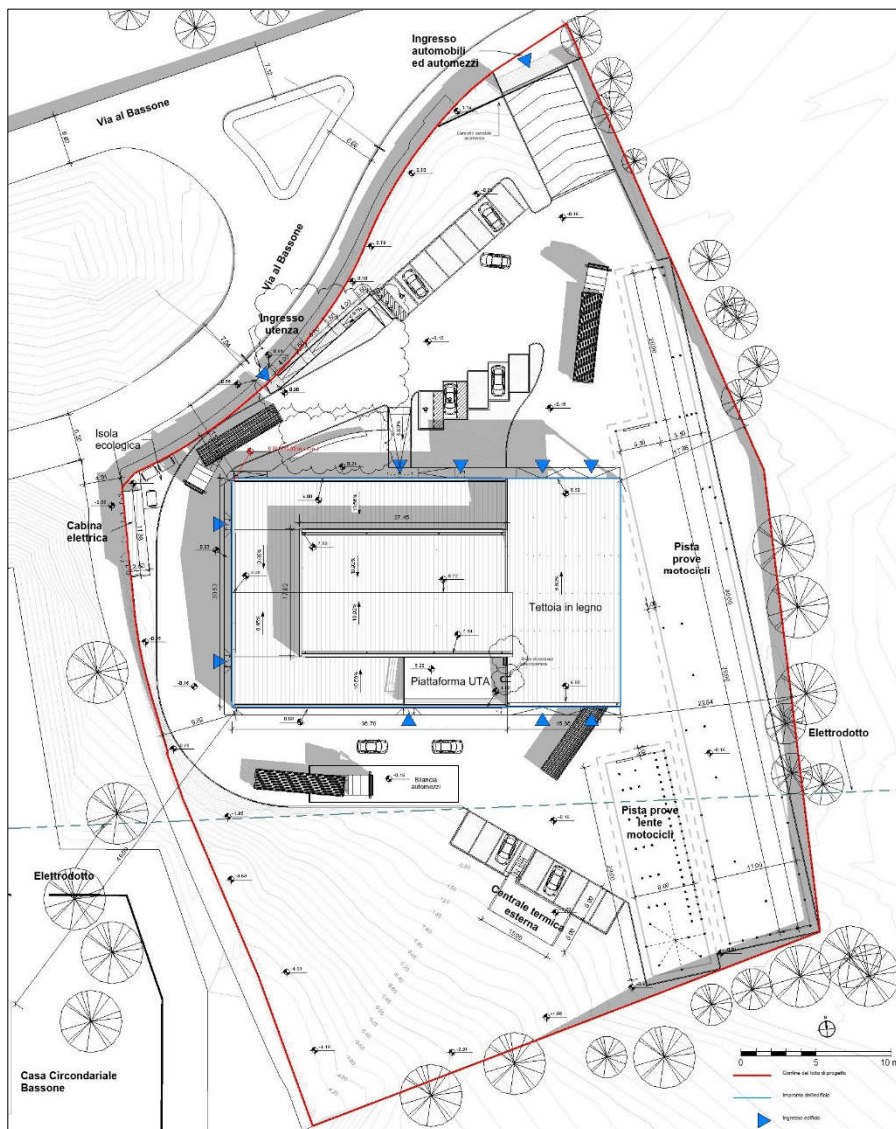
Planimetria del lotto di progetto – illustrazione della nuova sagoma dell'edificio e della predisposizione delle aree esterne – Fuori scala
